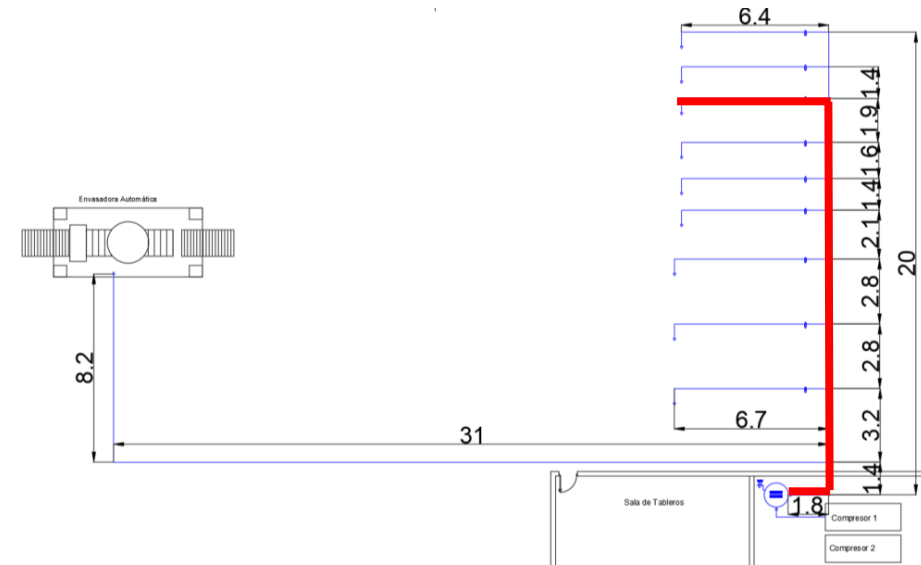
Layout verificación 9 de cañería de aire comprimido
